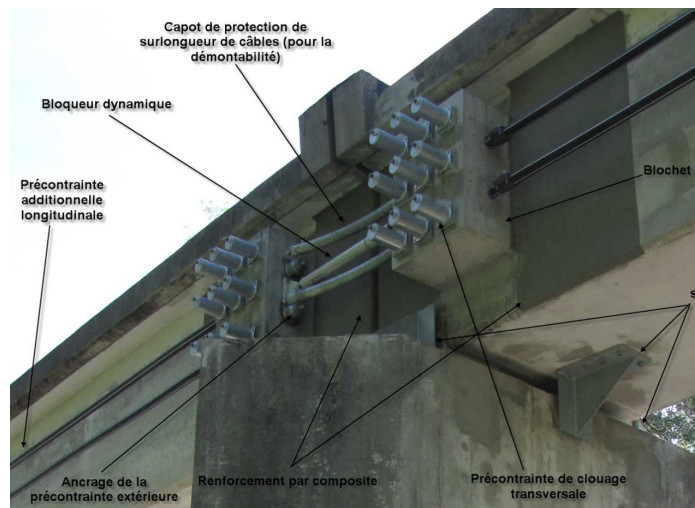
Détail d'un blochet d'ancrage et des travaux réalisés aux abouts de travée sur la pile P3 /
